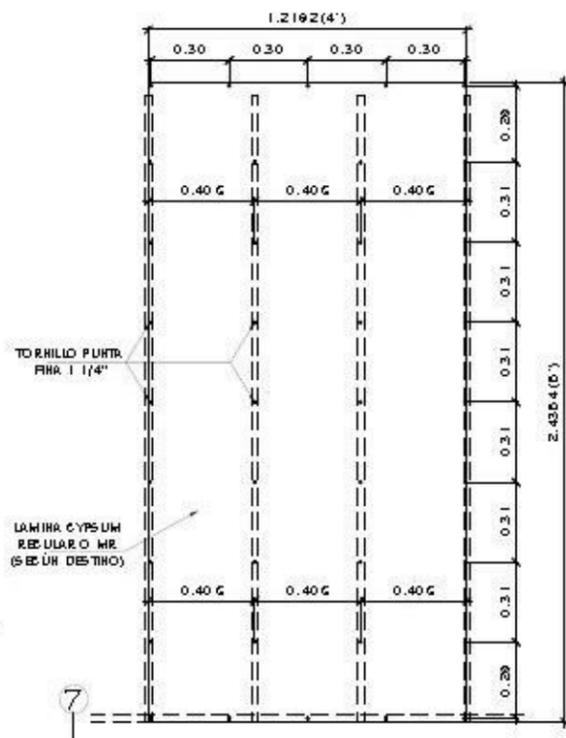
Detalle de Fijación de Lámina de GYPSUM
